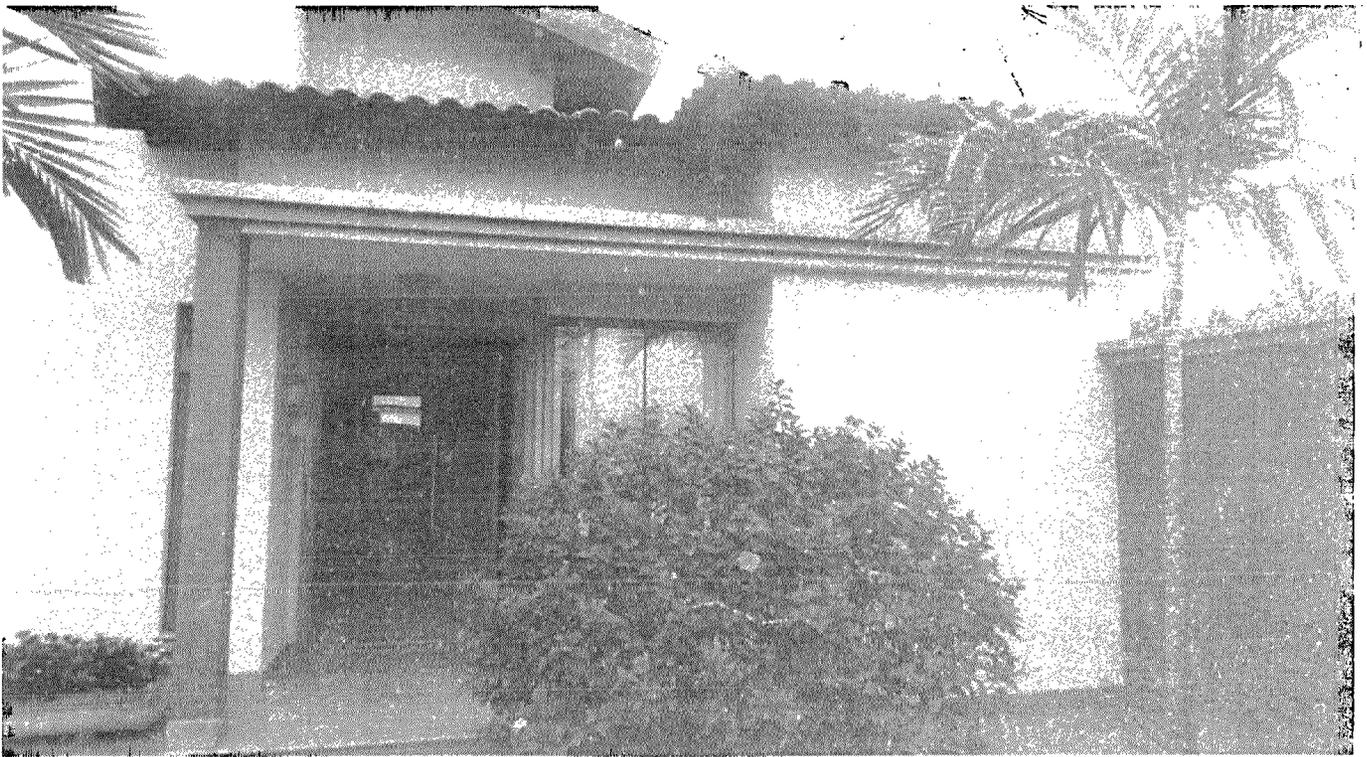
Fachada do imóvel penhorado – alto padrão construtivo.
